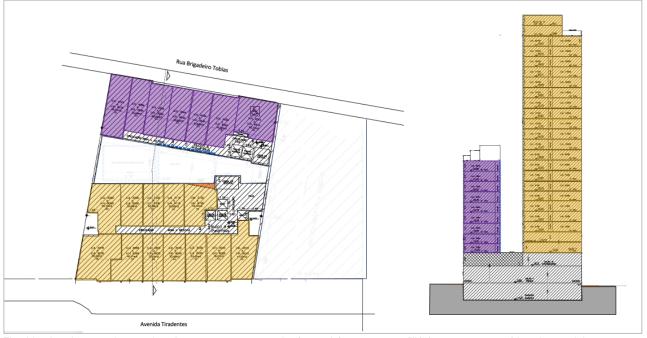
e 15: planta pavimento tipo. Apartamentos torre maior (amarelo), torre menor (lilás) e corte esquemático. Autor: elaboração própria, a partir do projeto. Fonte: acervo arquiteto Waldir Ribeiro – assessoria técnica Urbania.
